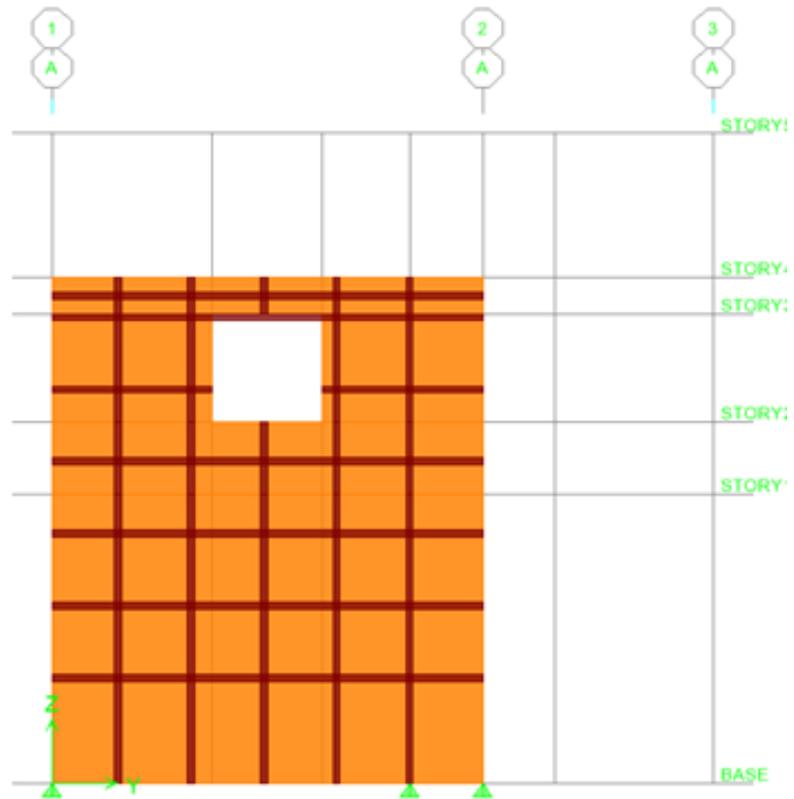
Colocación de refuerzos de madera de confinamiento (Elevación Lateral).
